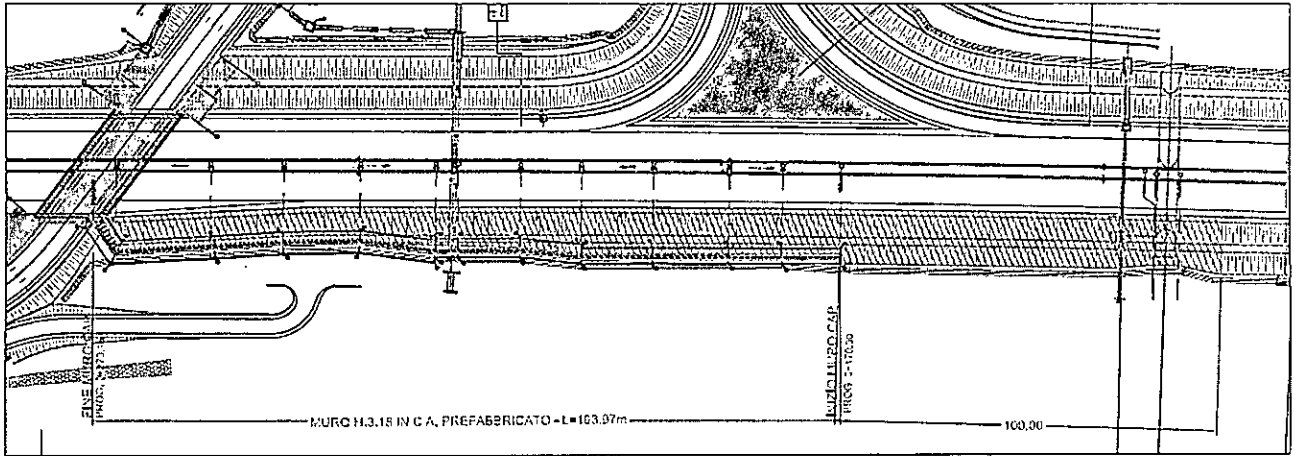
Stralcio planimetrico – Progetto Costruttivo – Proposta di modifica - Proposta di variante muro in c.a. prefabbricato MU18
